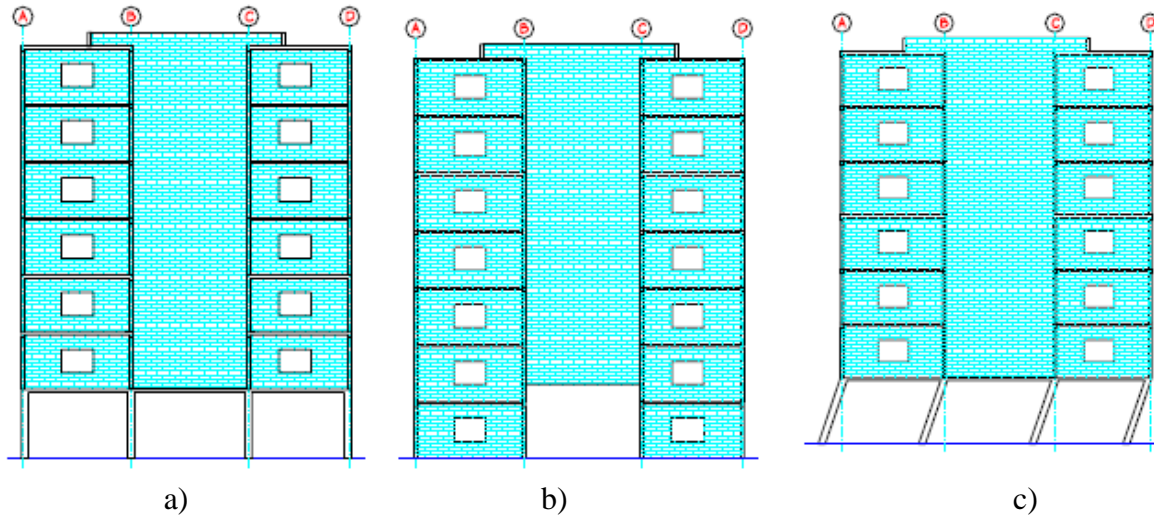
Ejemplos de planta baja débil: a) Planta baja débil, b) Variación de la planta baja débil, c) Modo de falla típico
